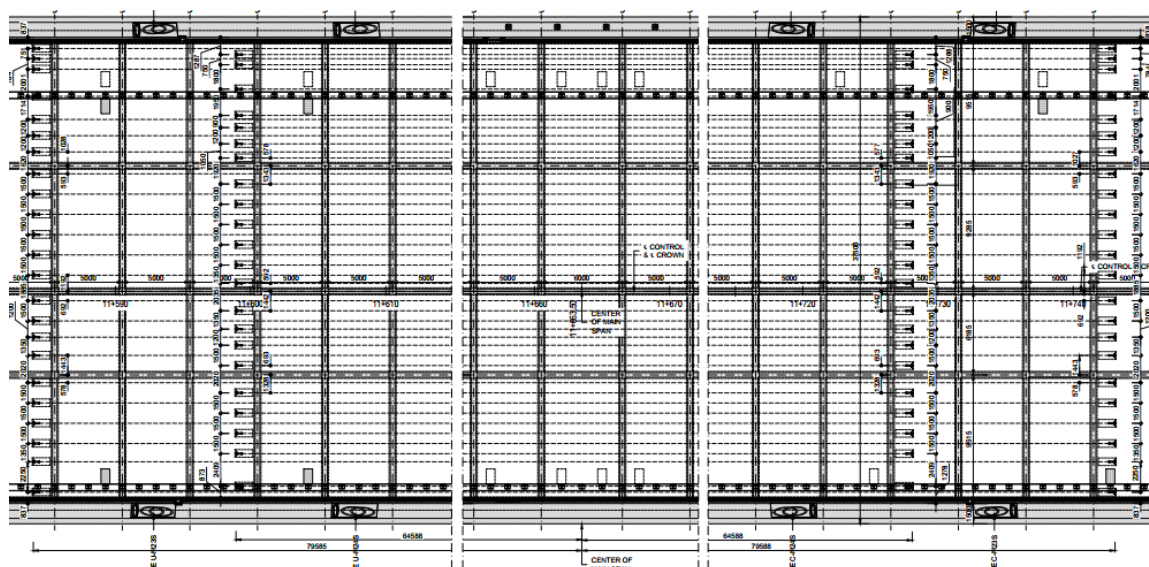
Disposición del pretensado longitudinal en centro de vano.
